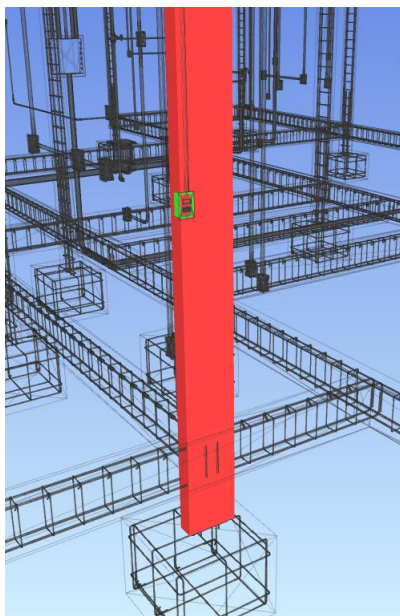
Incompatibilidade entre eletroduto (verde) e viga baldrame (vermelho)
